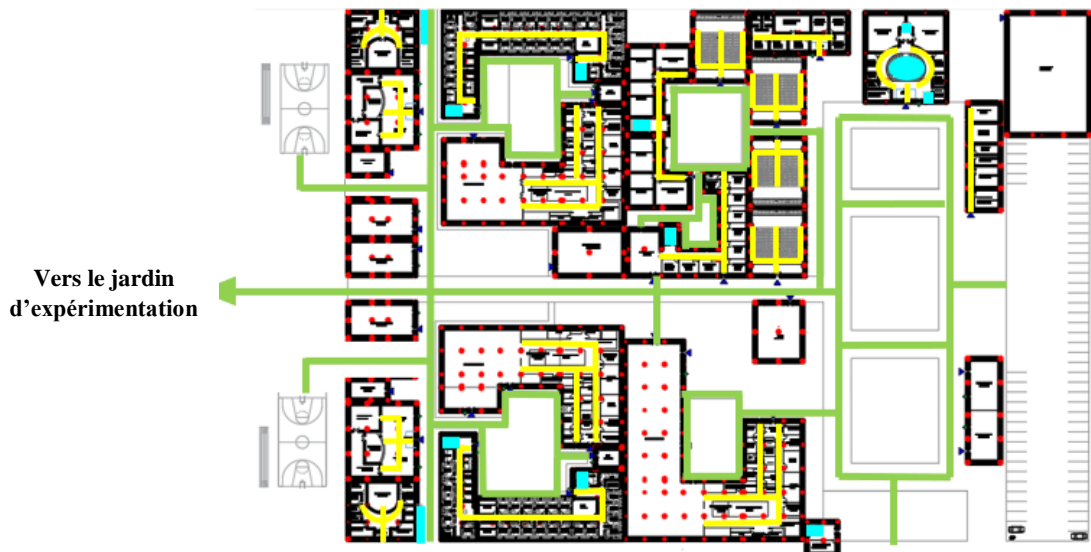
Parcours de la circulation horizontale et verticale au rez de chaussée
